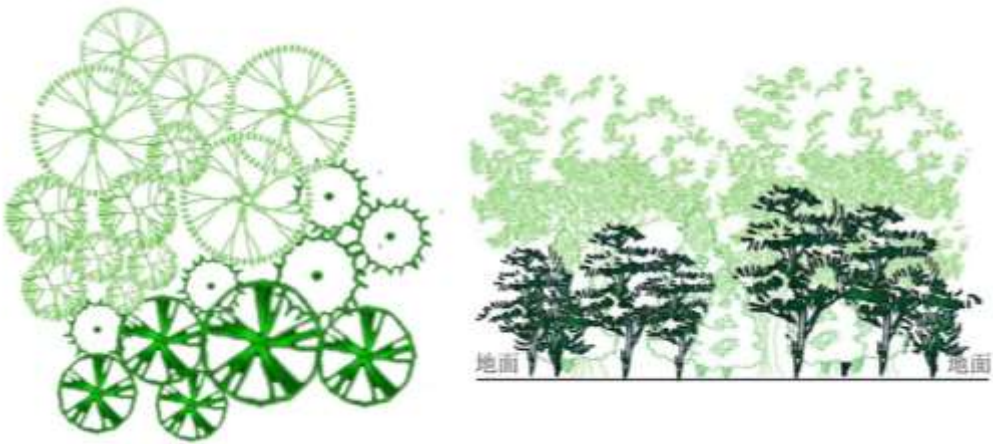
和E.2给出了相同树种群植的平面和立面图，图E.3不同树种群植的平面和立面图。
